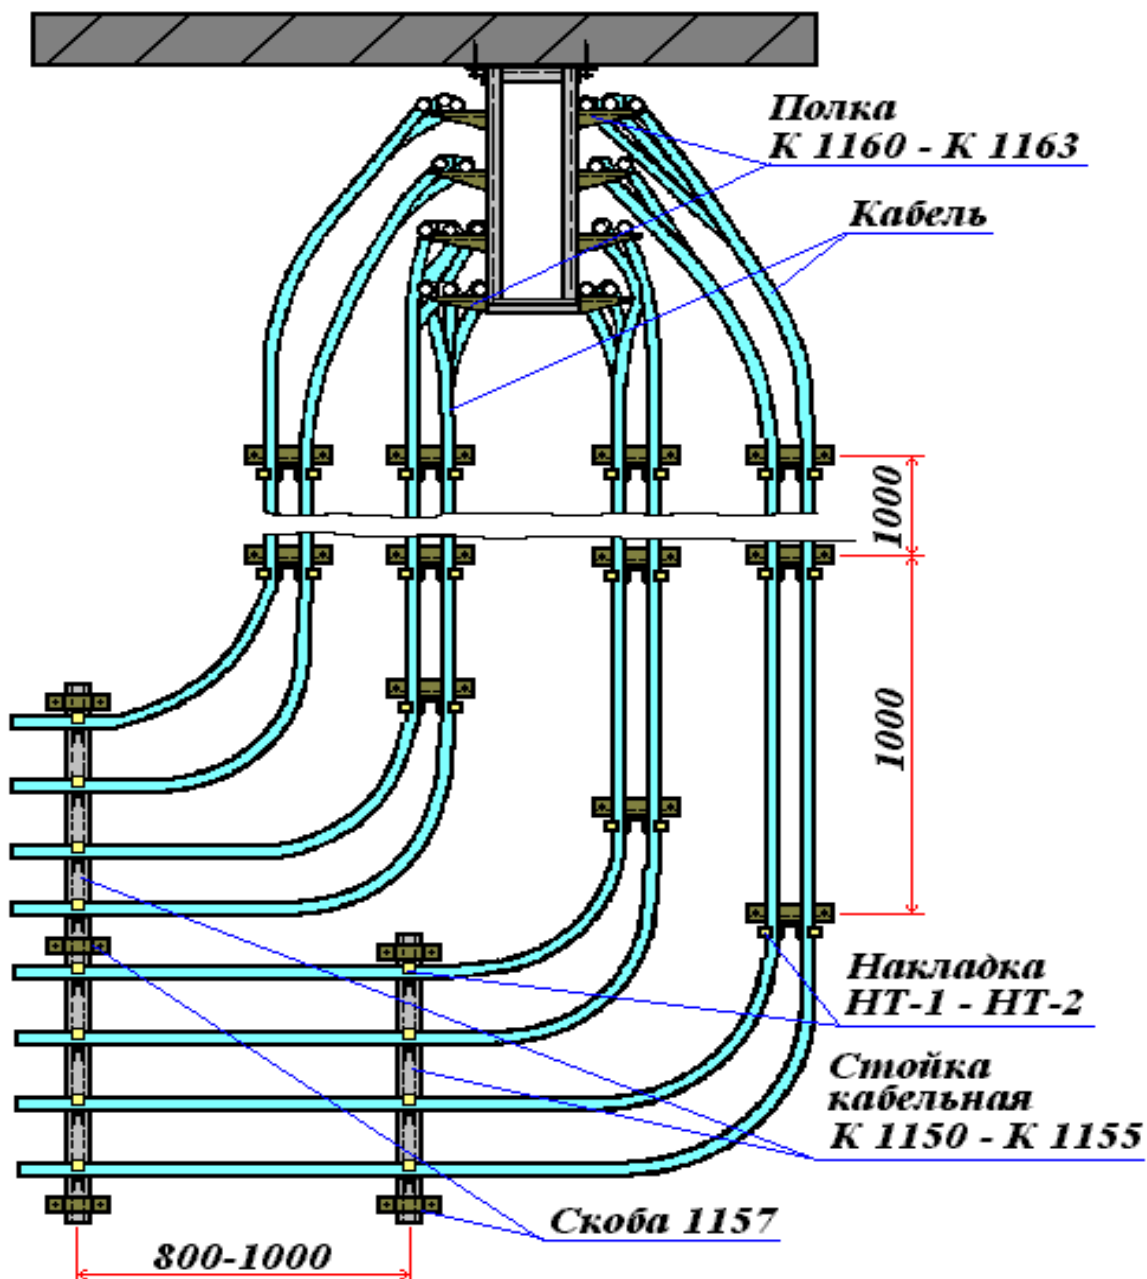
Прокладка кабеля по конструкциям
